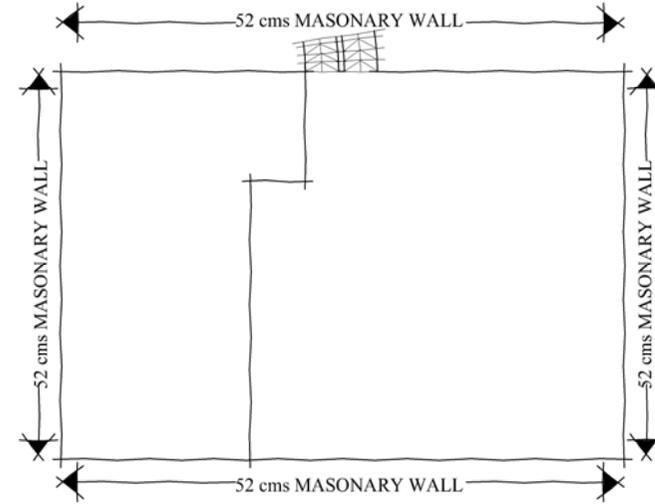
المسقط الأفقي للدور الأول
